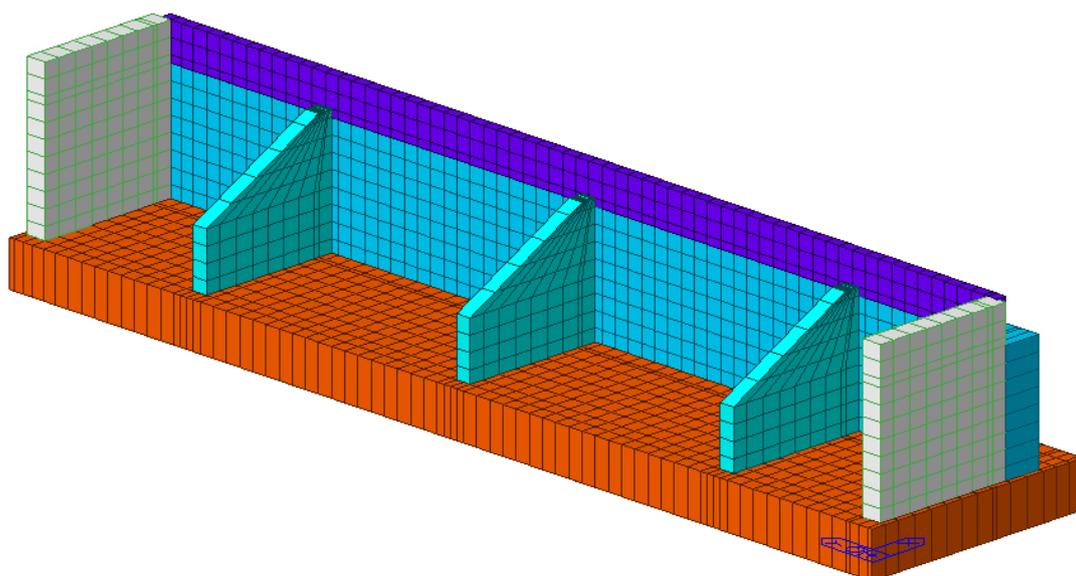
Modello 3D della spalla S1/S4– Vista posteriore
